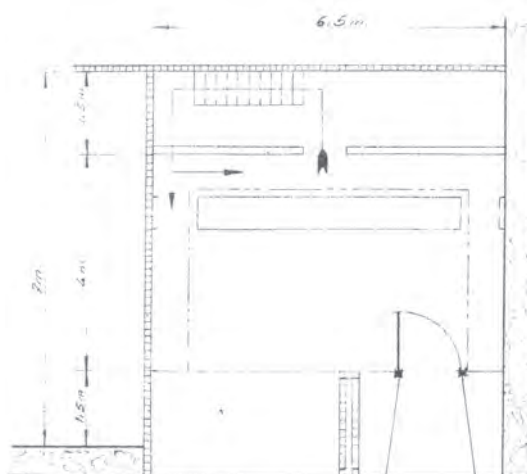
27. PLANTA DE MERCERÍA ²⁰
